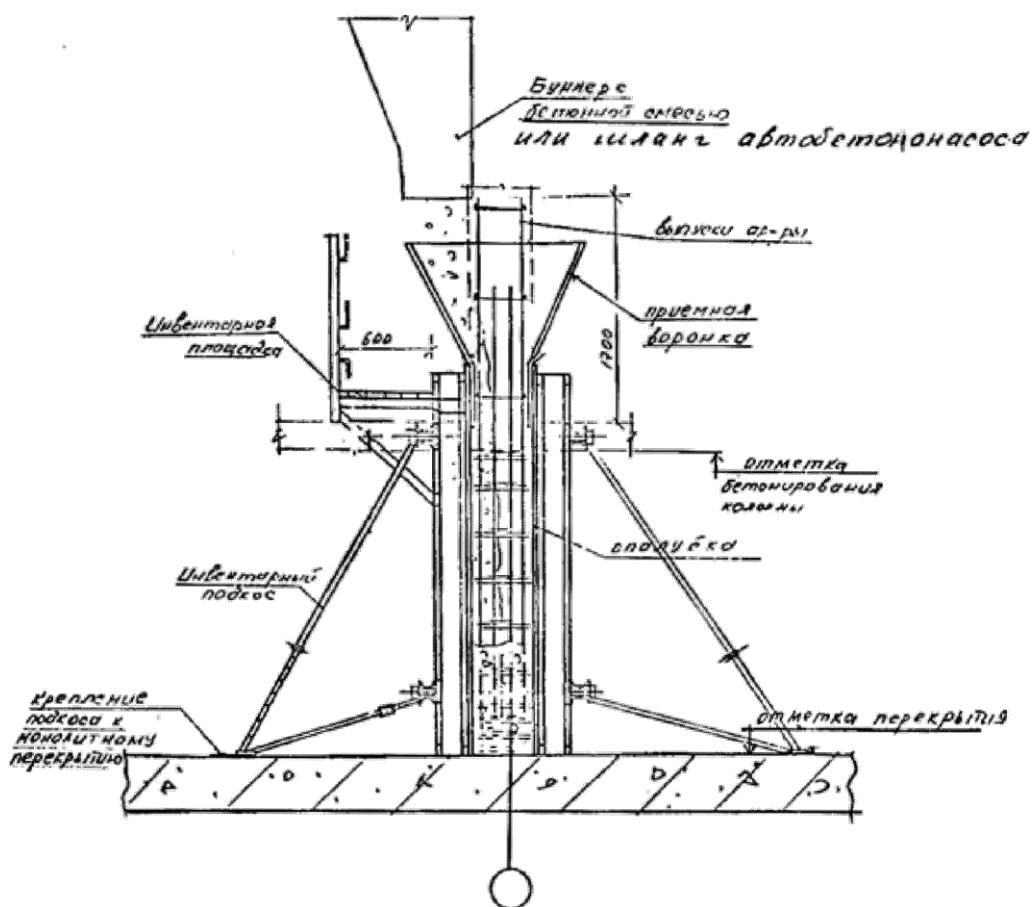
Прием раздаточного поворотного бункера с бетонной смесью
